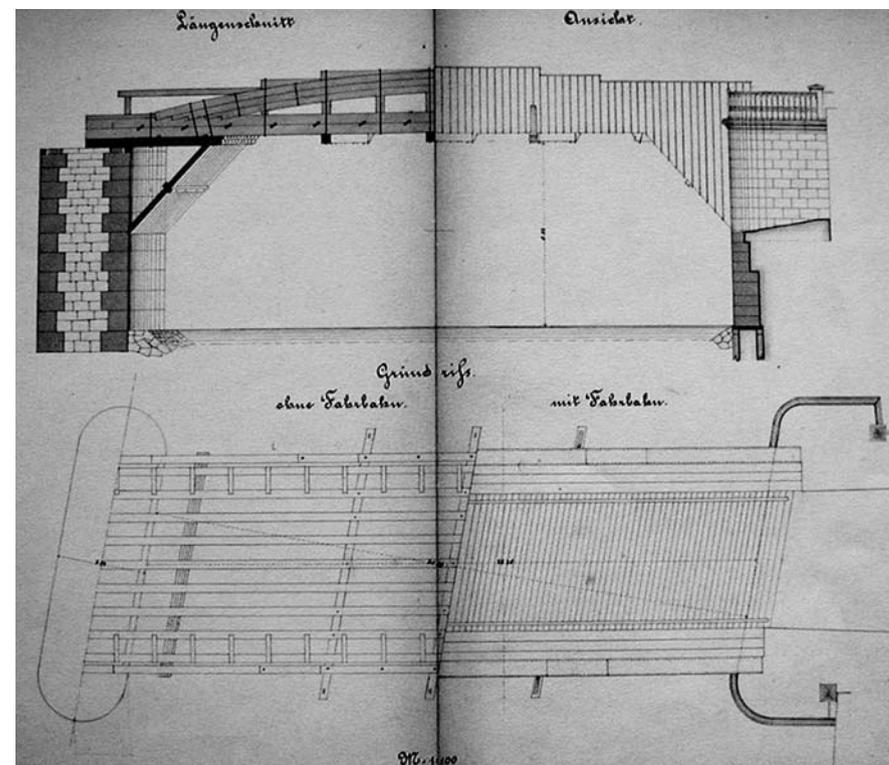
(Kat. 69): Längsschnitt und Grundriß der Elisenbrücke (Brücke b 23), Neuburg 15. Juni 1886.
